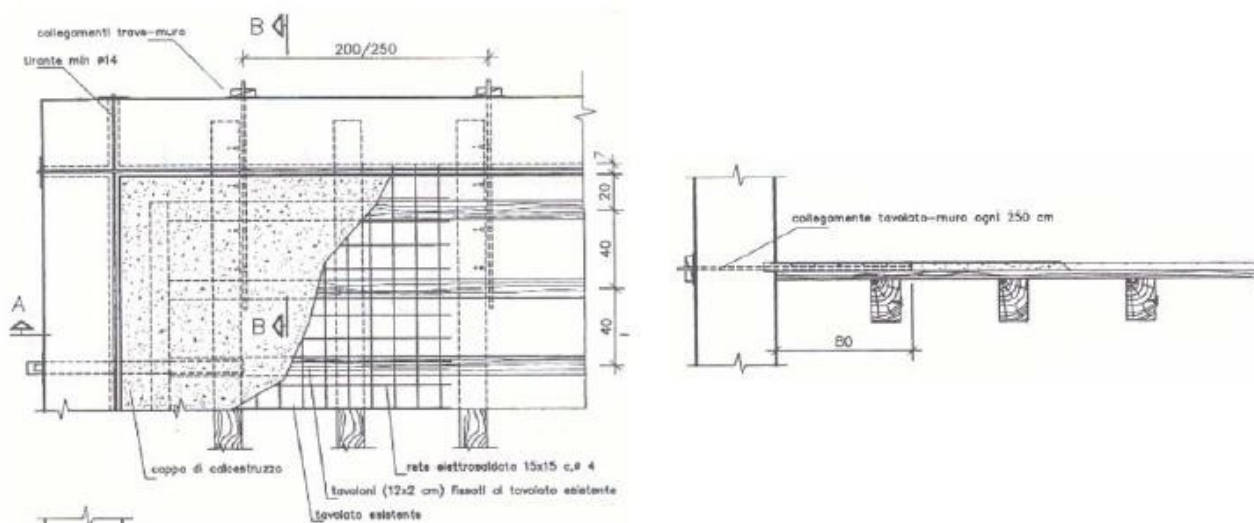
Pormenores da colocação de lajeta de betão sobre pavimento de madeira (Lombardo et al.;1997).
